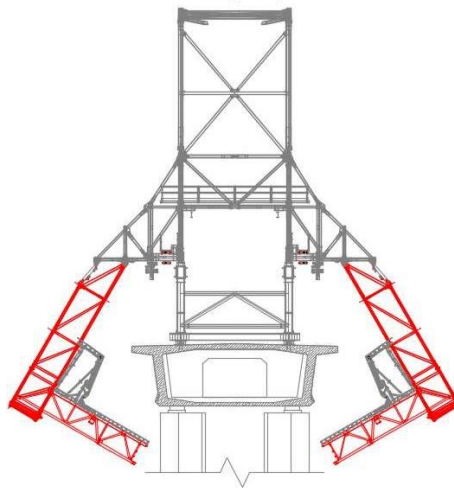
Estrutura transversal – Fase de lançamento.
